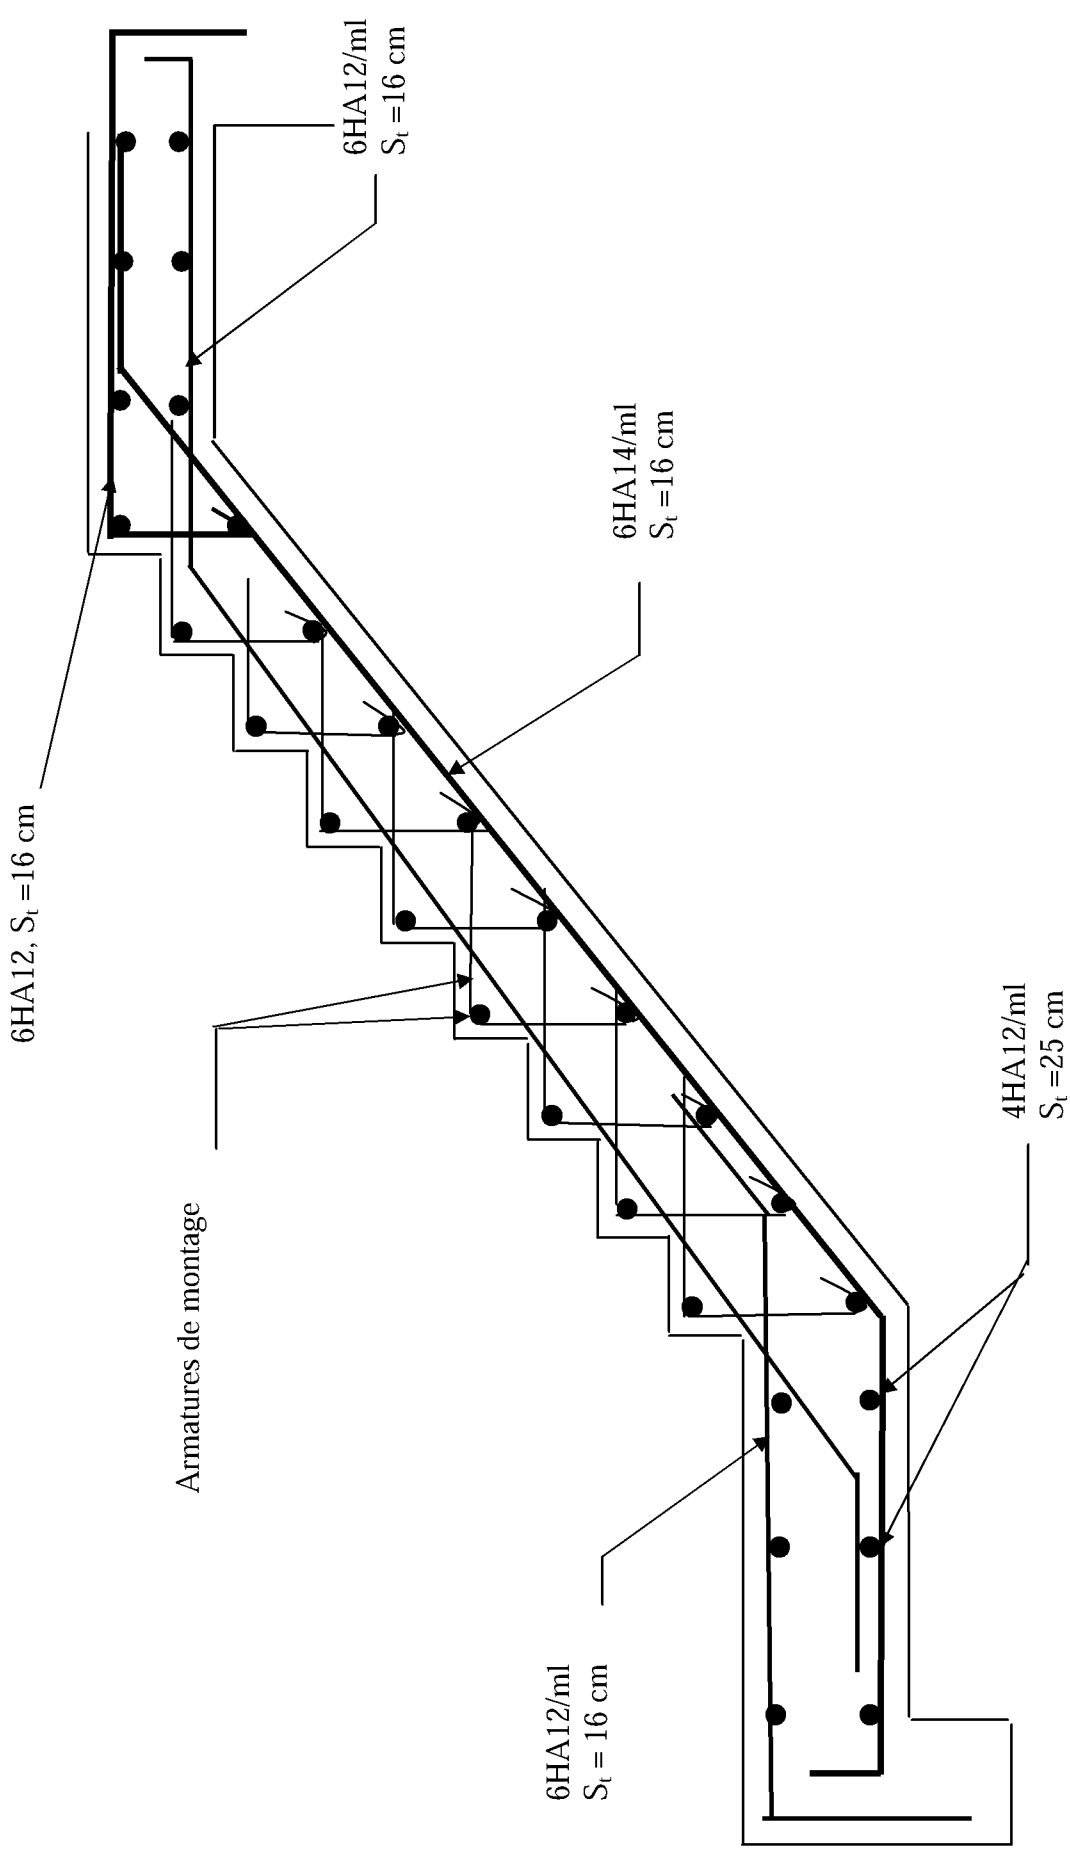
Schéma De Ferrailage Des Escaliers
